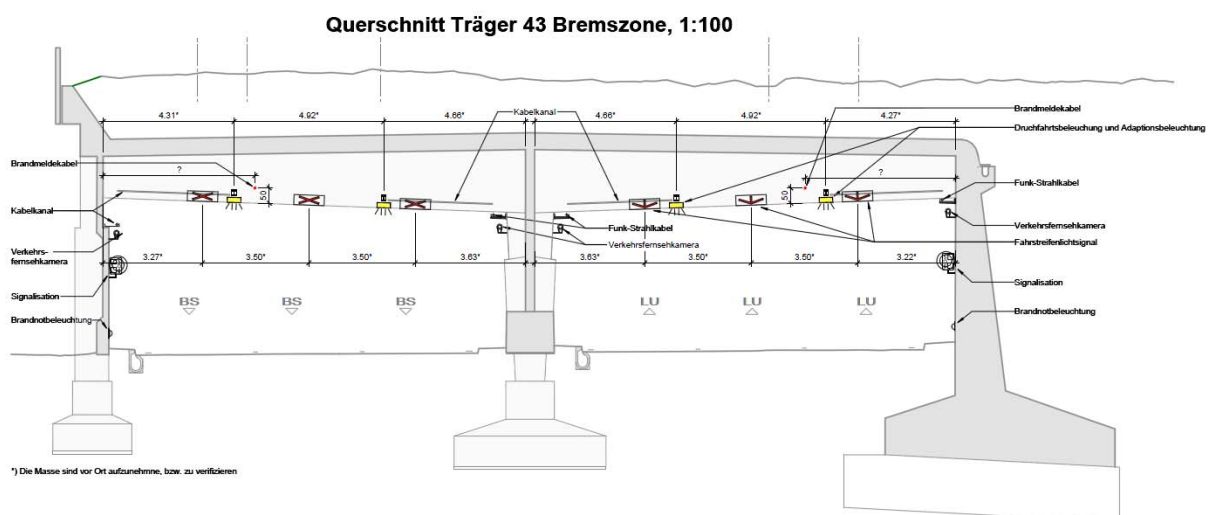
Schemaquerschnitt Tunnel mit BSA
